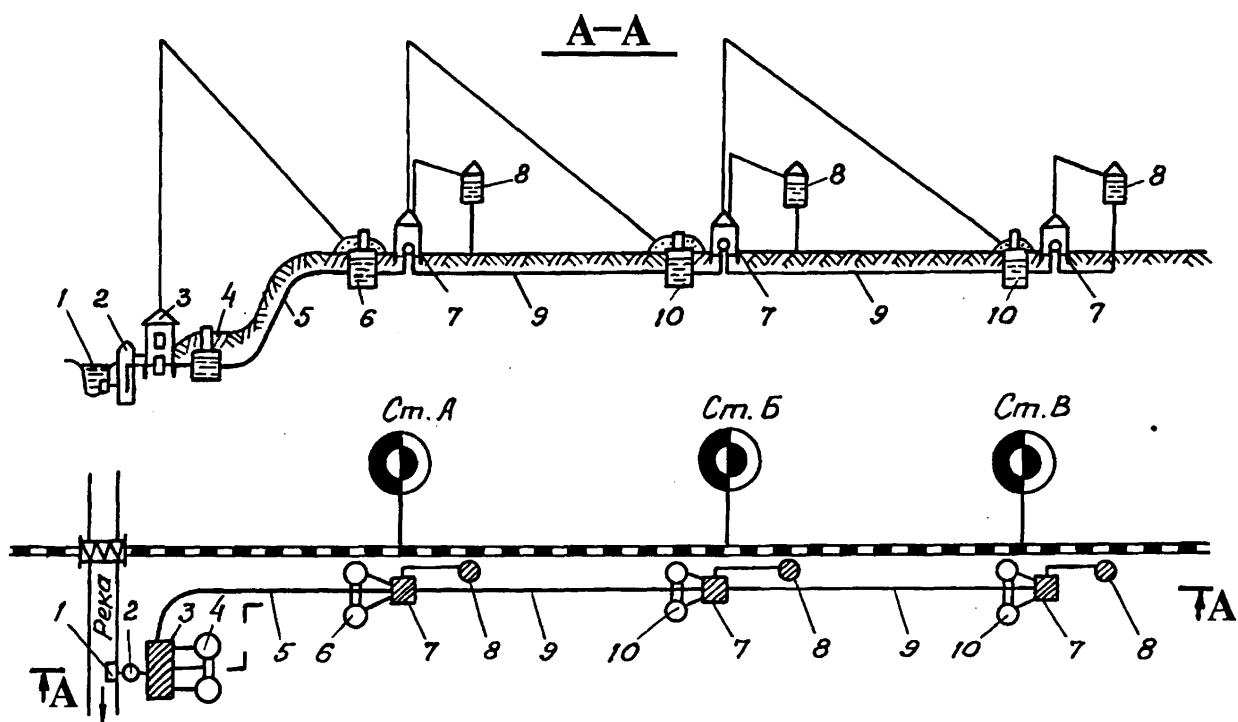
Схема водоснабжения с продольными водопроводами:
